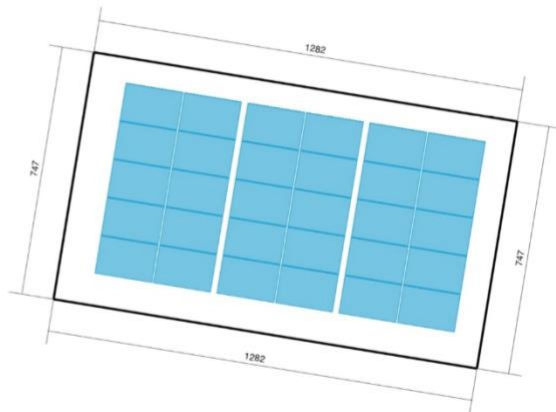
Bürgerfeldstrasse 2.1, Belegungsplan, Dachfläche 3
